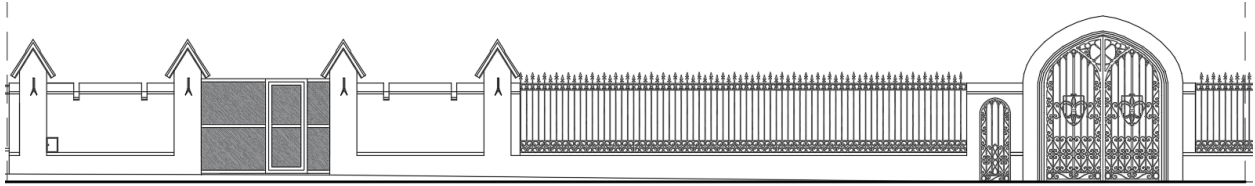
Elevación cierro Triana 865. Fuente: Elaboración propia.
